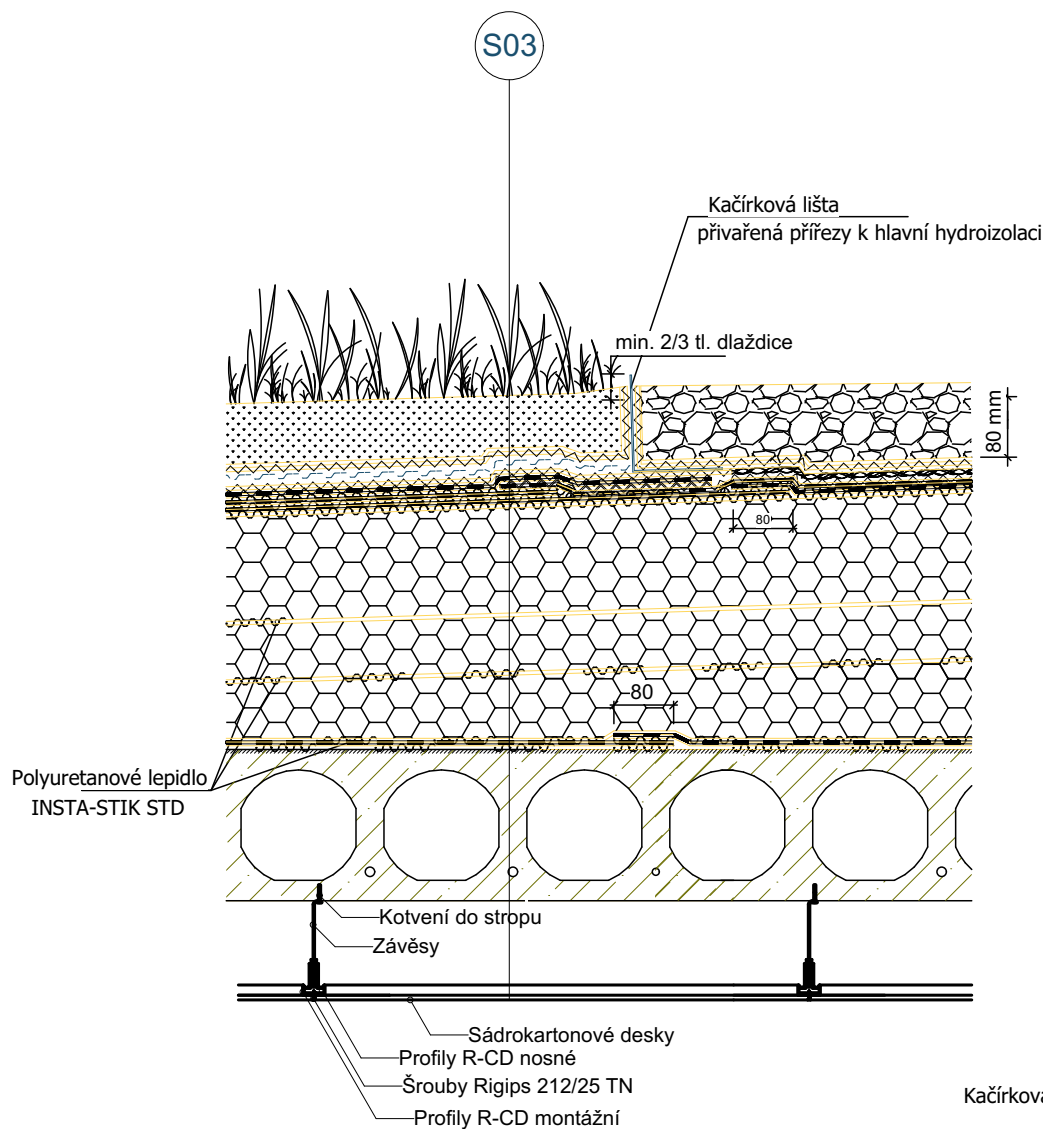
DETAIL VEGETAČNÍ STŘECHY A DETAILEM OKRAJE STŘECHY M 1:10
